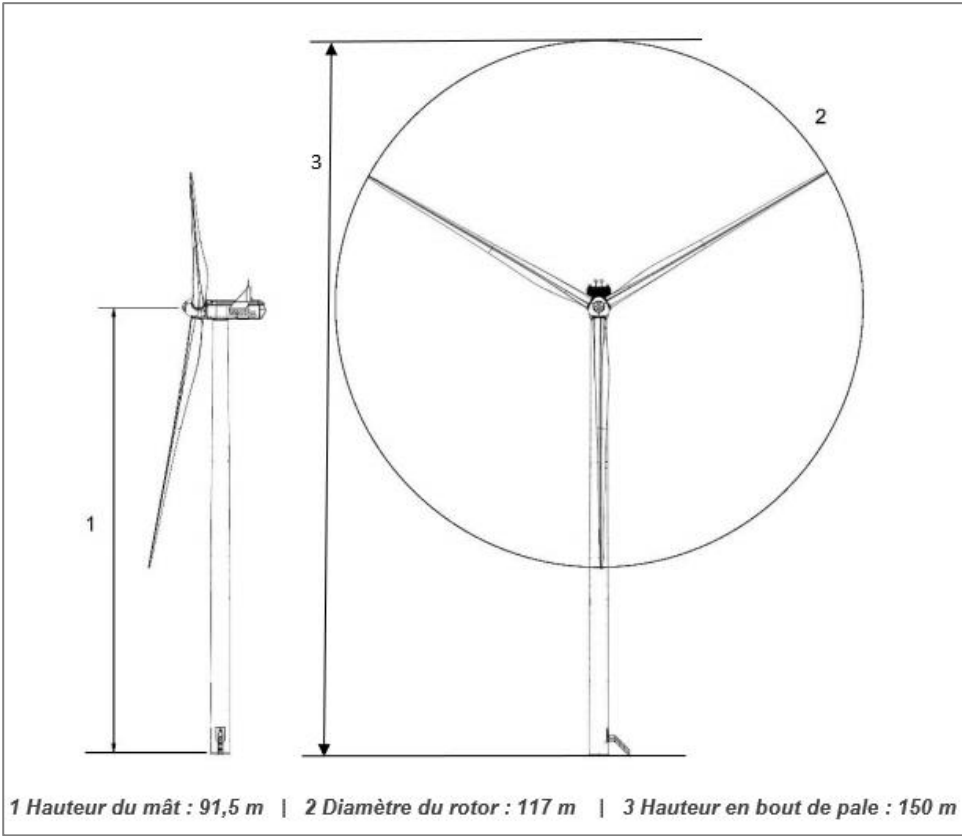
Plan d'élévation des éoliennes E03 à E08 : V117 Hauteur hors tout 150m
